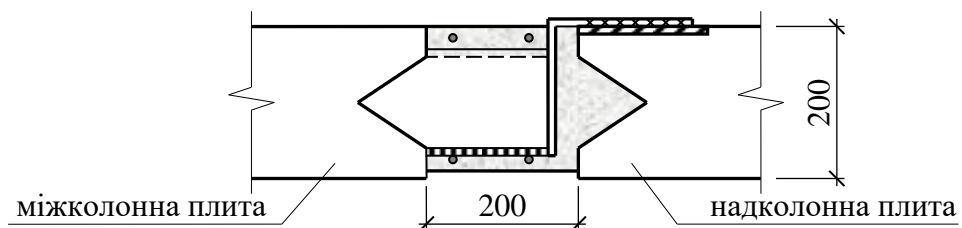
Вузол сполучення міжколонної та надколонної плит
